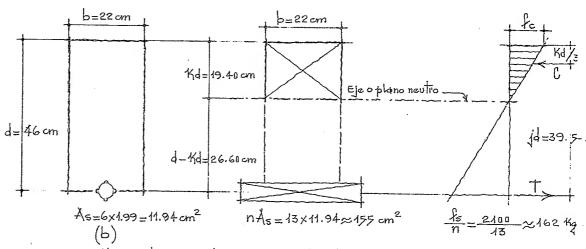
b. Corte traus\_ versal de la viga. Fig. 3.24. Area transfor\_ modo de la sección. Fig. 3.25. Diagramo de fatigas. Haciendo momentos con respecto al plano nentro, se tiene:
